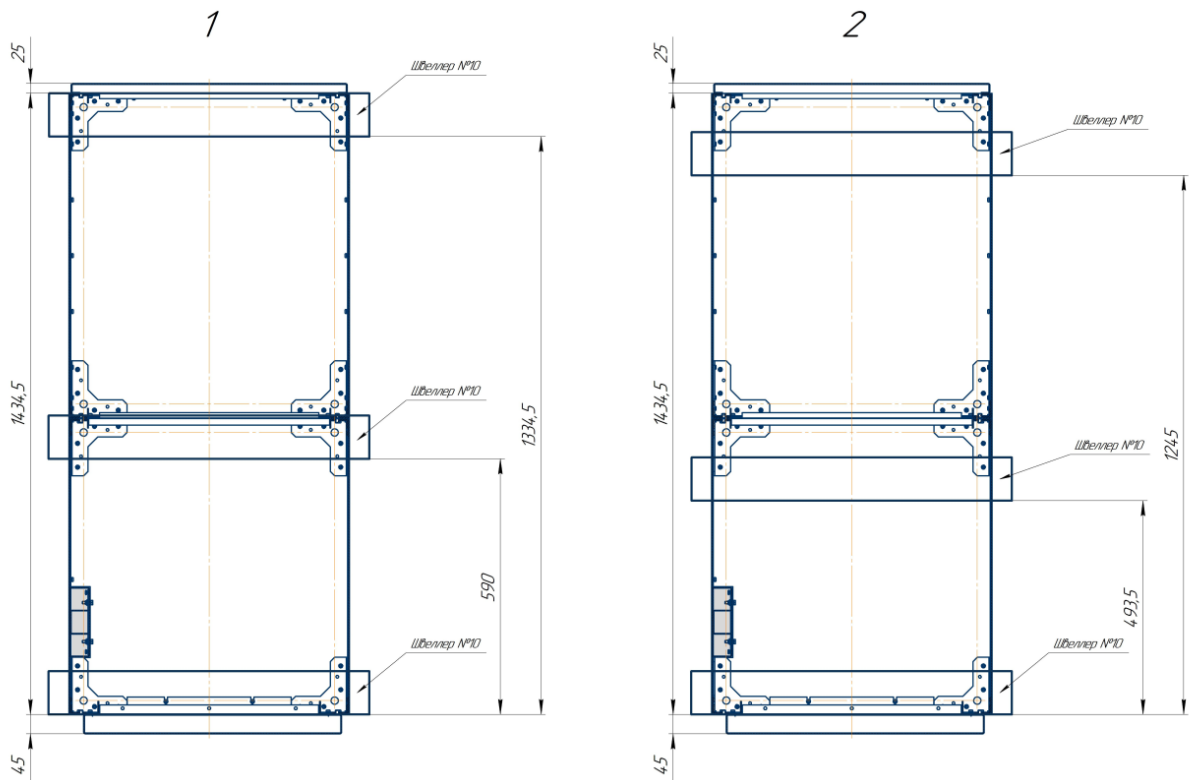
Схема установки закладных швеллеров для установки КРУ-70-BLISS
